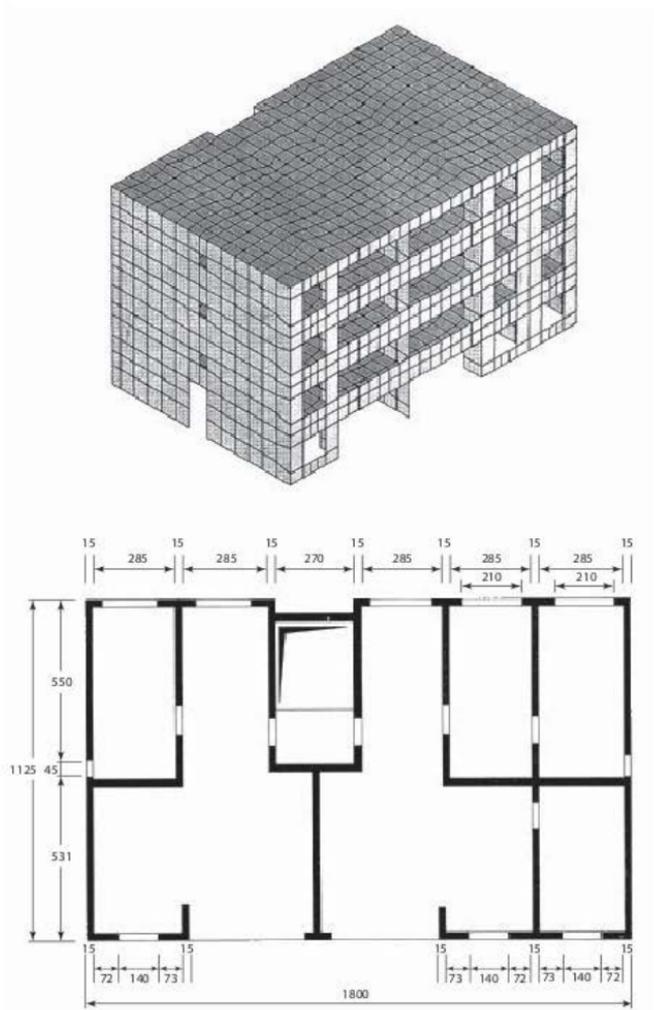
Perspective et vue en plan du bâtiment
